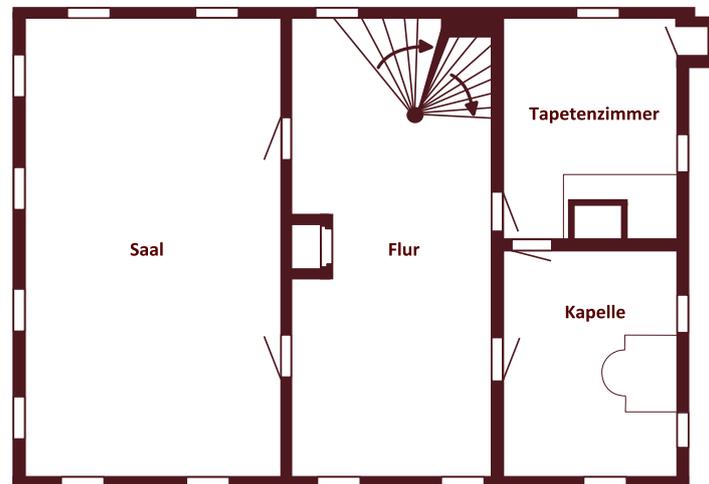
Grundriss 2. Obergeschoß
